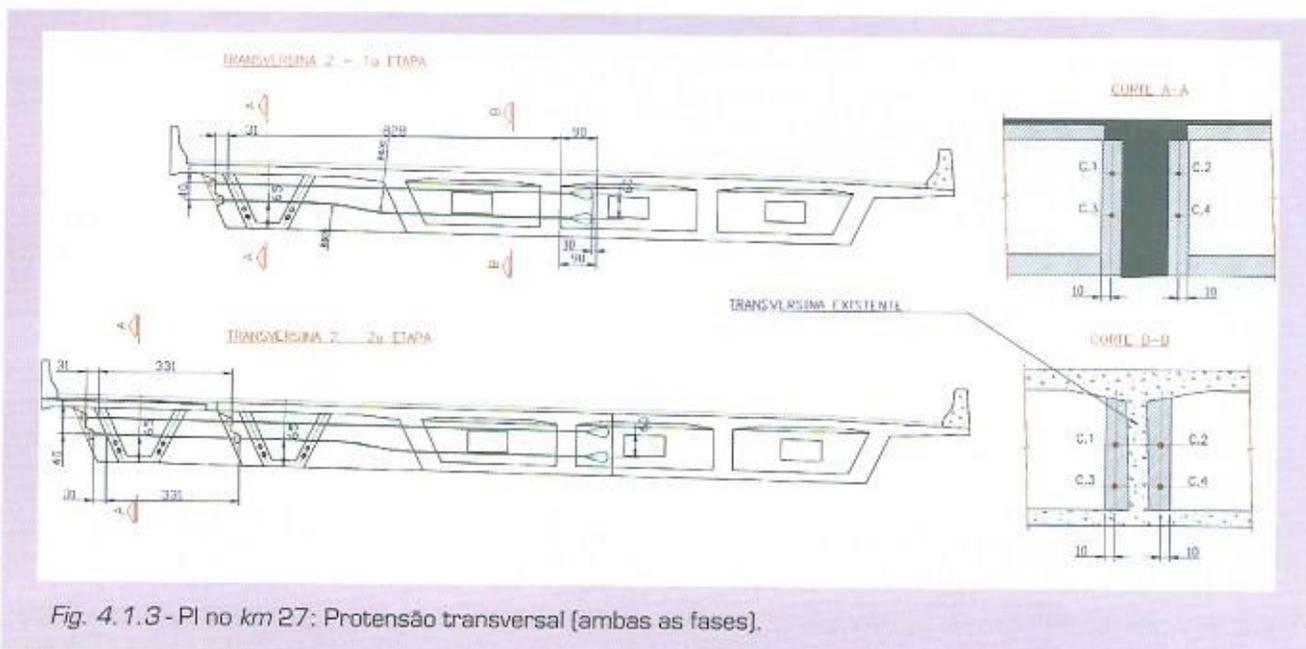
PI no km 27: Protensão transversal (ambas as fases).
